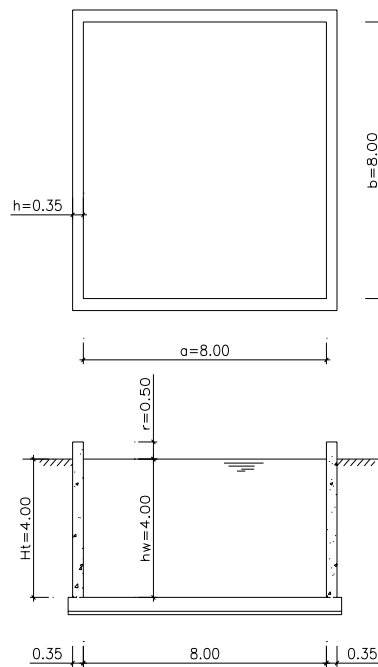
Cálculo de la pared de un depósito rectangular de hormigón armado
